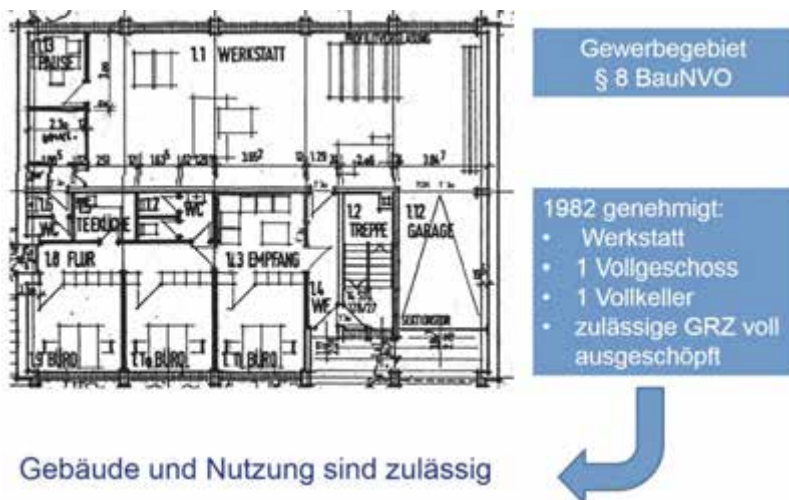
Werkstattgebäude (Erdgeschossgrundriss) zum Zeitpunkt der Baugenehmigung
